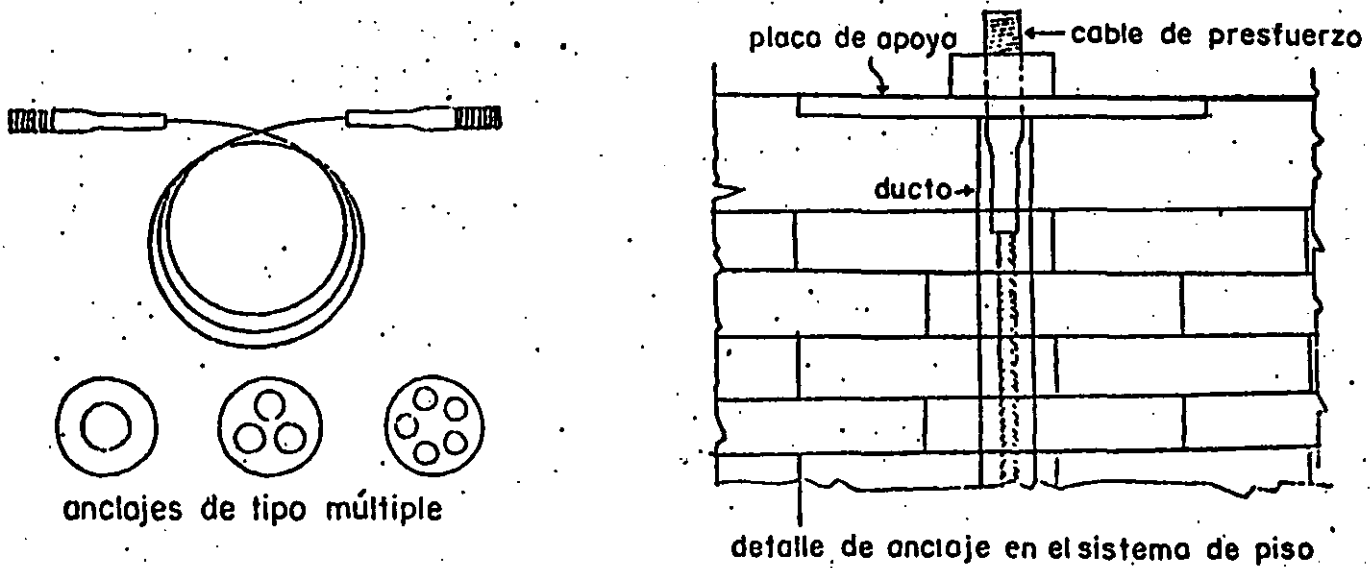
Aplicación del sistema de postensado RAMSA en mampostería.
